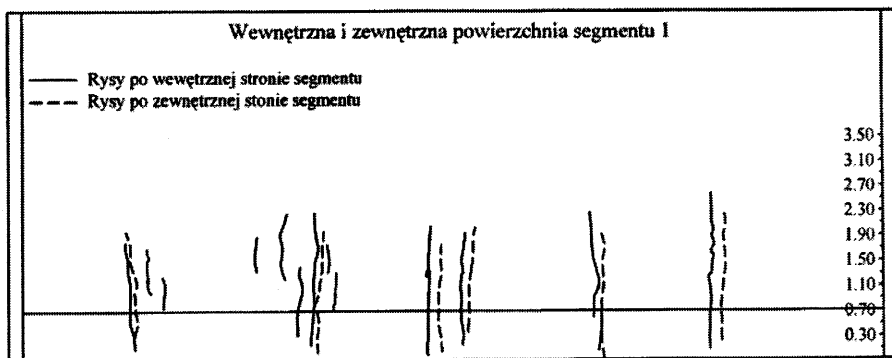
Układ rys na wewnętrznej i zewnętrznej powierzchni segmentu 1
